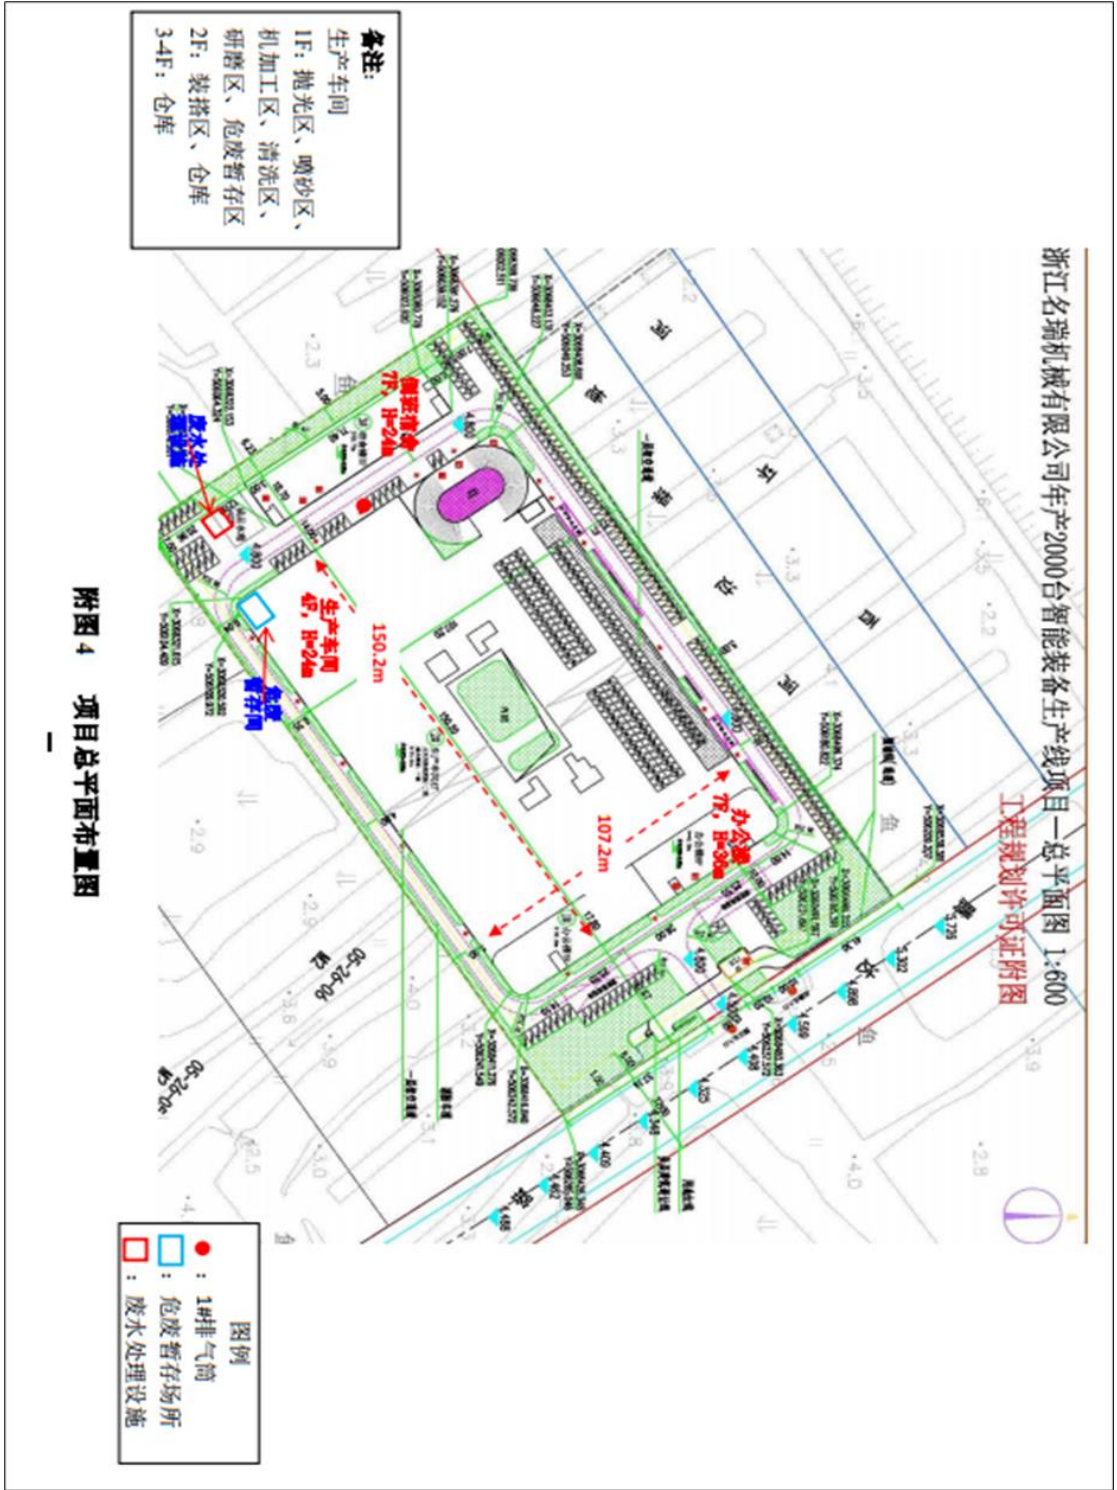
浙江名瑞智能包装科技有限公司厂区平面布置图
